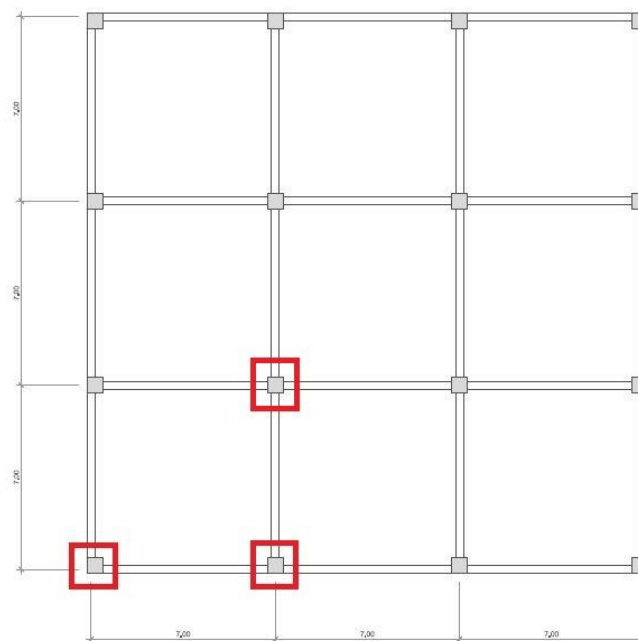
Planta do edifício com a respetiva localização dos pilares exteriores e interiores a serem removidos para estruturas com Categoria de Ocupação IV
